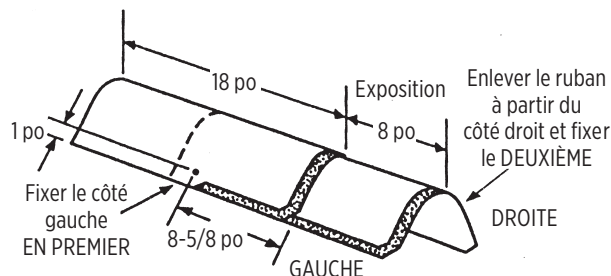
Pose de bardeaux Shangle Ridge sur les arêtiers et les faîteages.
